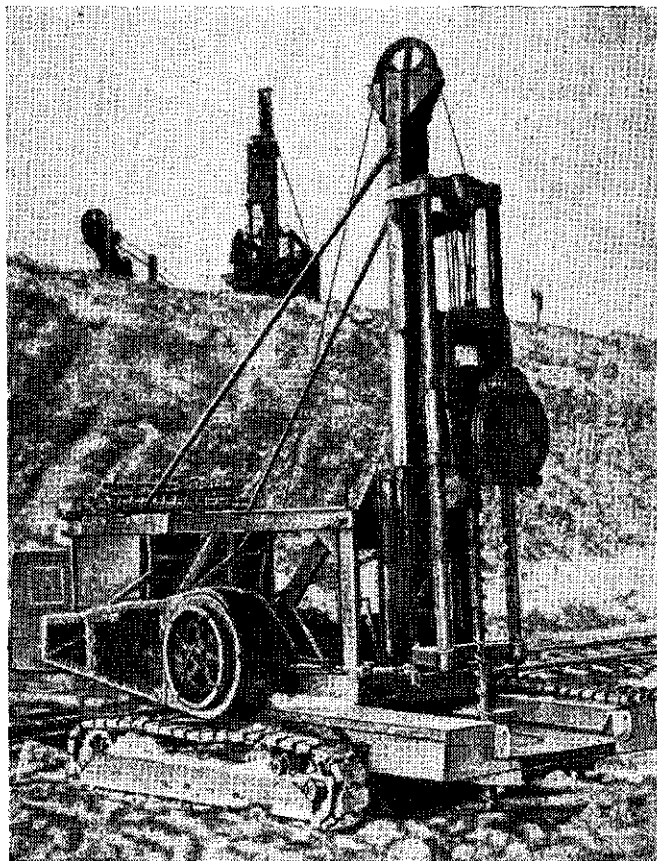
Общий вид бурового станка БУ-2 с приспособлением для вращательного бурения ПВБ-150
